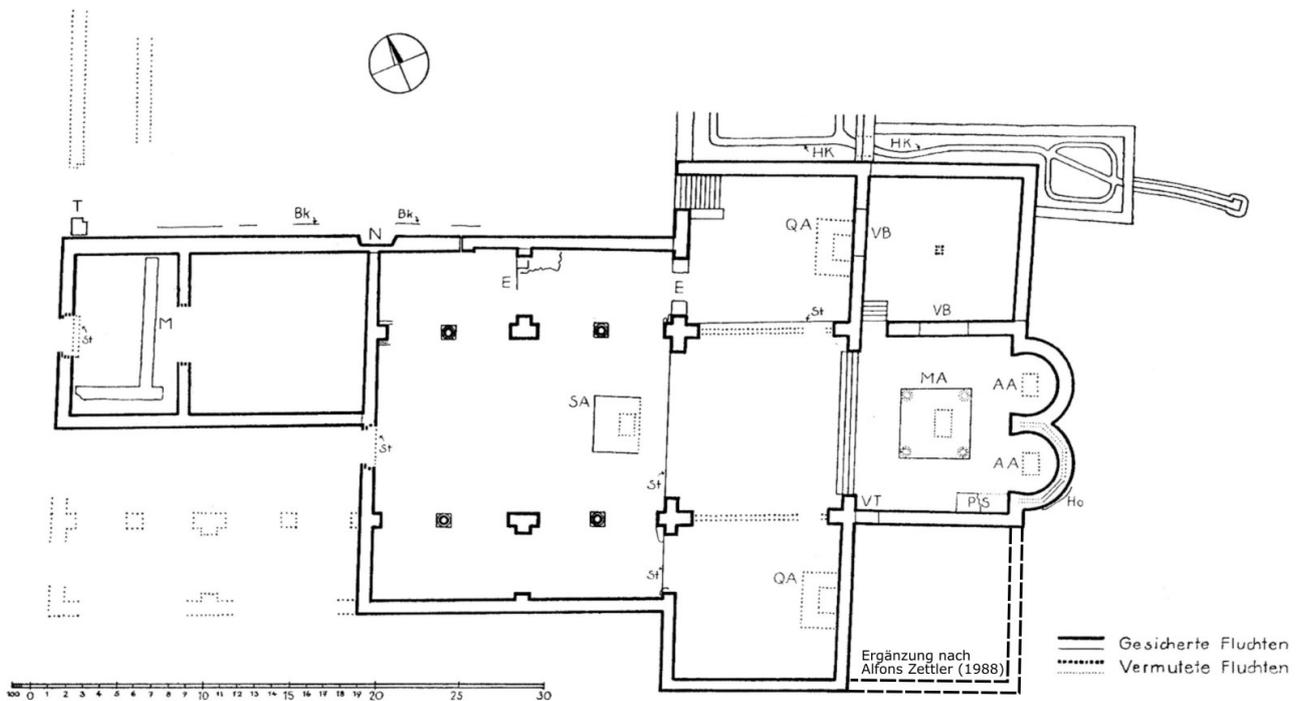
Der Grundriss des unter Abt Heito errichteten Marienmünsters von Reichenau-Mittelzell nach Emil Reisser (1960)
